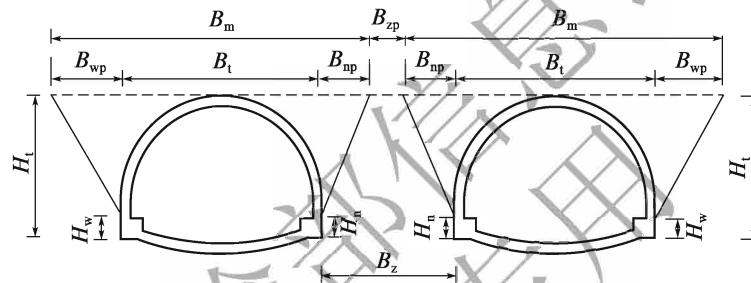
3-3 Schéma de calcul des charges du tunnel bitube avec pilier central ($B_{zp} > 0$)
